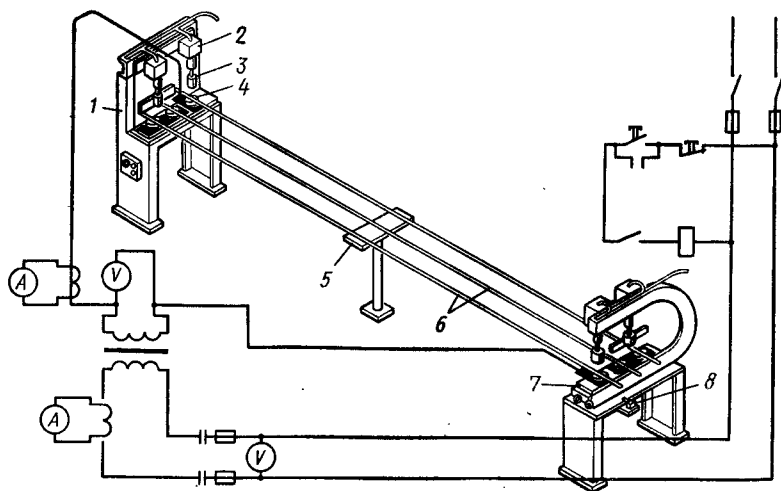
Установка для электронгрева стержневой арматуры вне формы: 1 — неподвижная опора; 2 — пневмоцилиндр; 3 — прижимная губка; 4 — токопроводящая губка; 5 — средняя опора; 6 — нагреваемые стержни; 7 — подвижная опора; 8 — конечный выключатель
